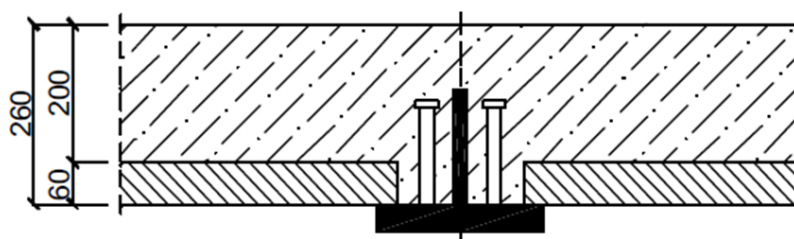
Secção transversal do pavimento misto *slim floor*, parque de estacionamento *DEZ*, *Innsbruck*-Austria [1].
